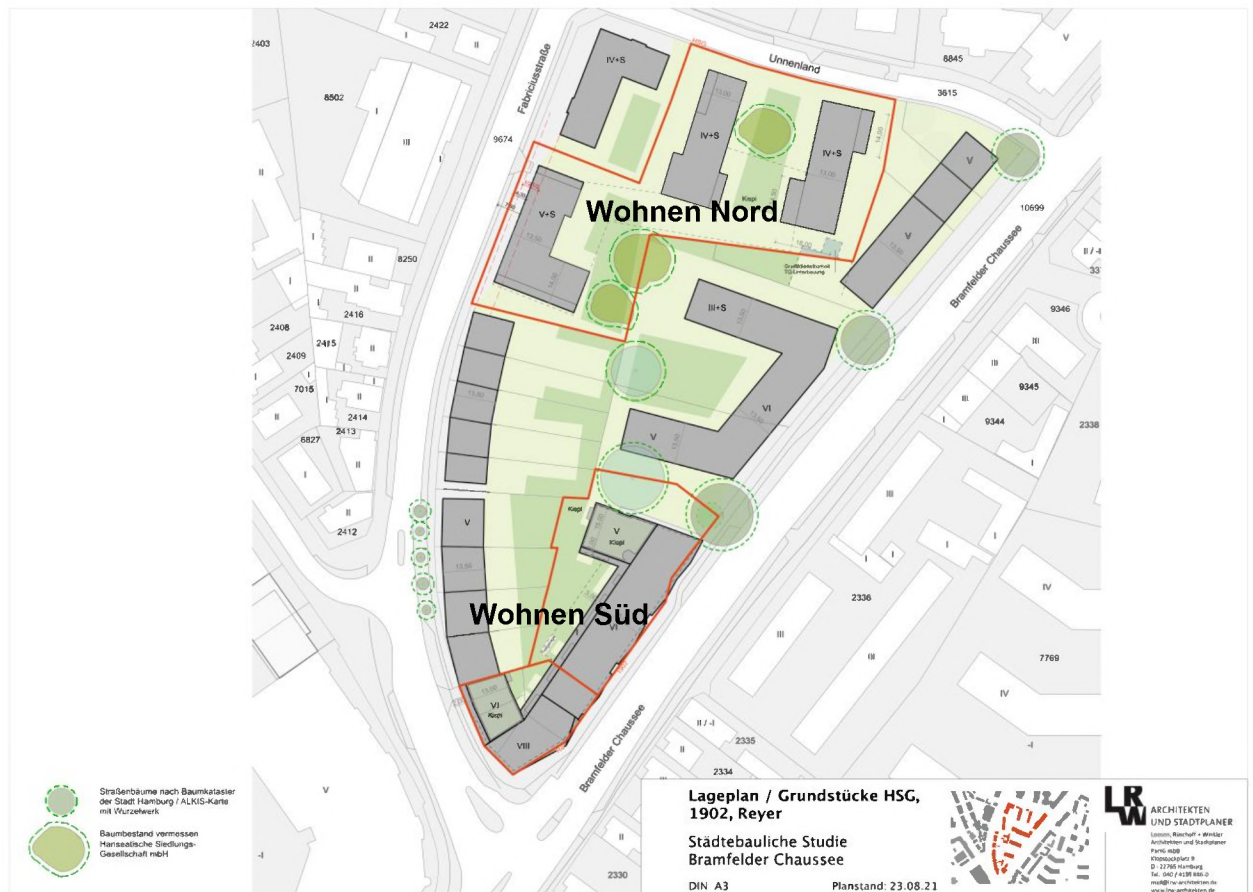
Übersicht Lageplan städtebauliche Studie, Stand: 23.08.2021 Quelle: LRW Architekten und Stadtplaner
